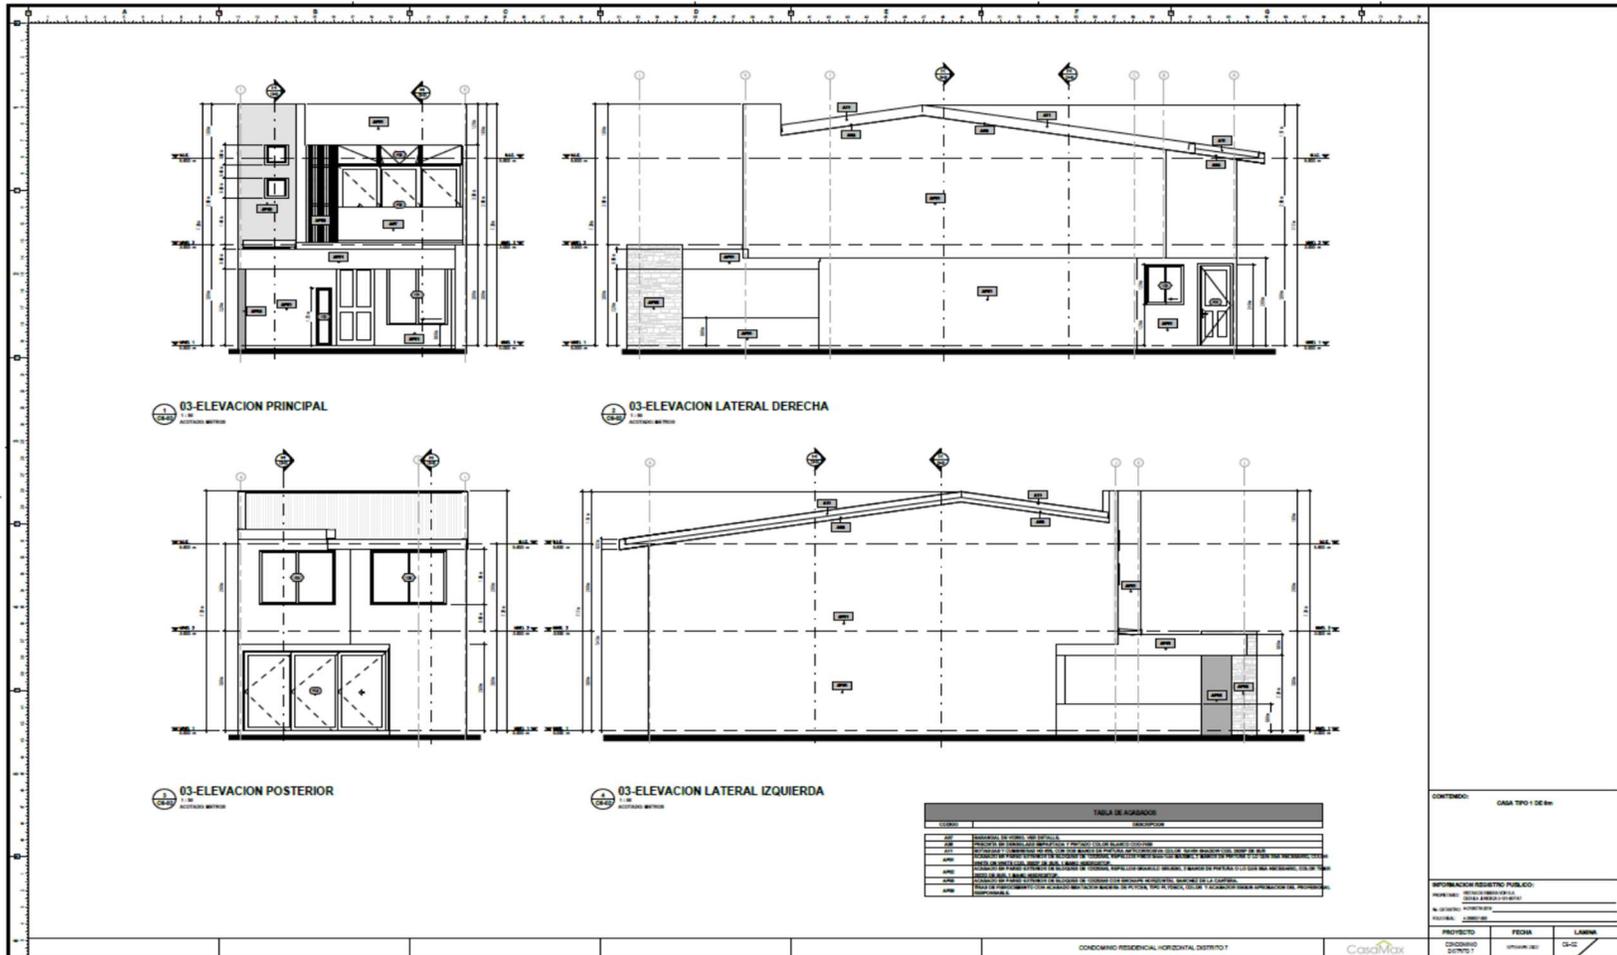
Elevación Arquitectónica, Casa Modelo Tipo # 1. Lámina # C6-02
